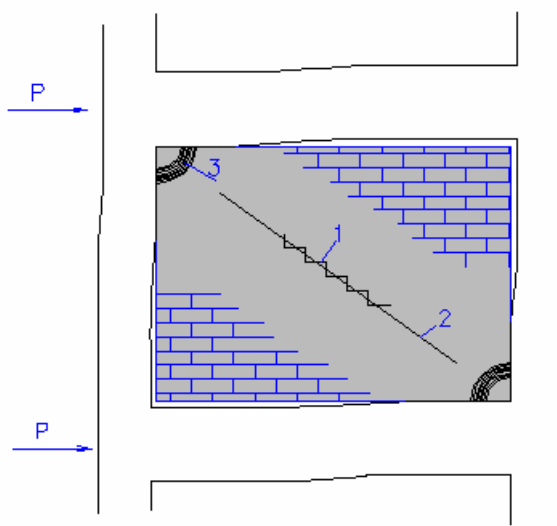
Modos de fissuras em painéis de alvenaria (Smith,1967)
